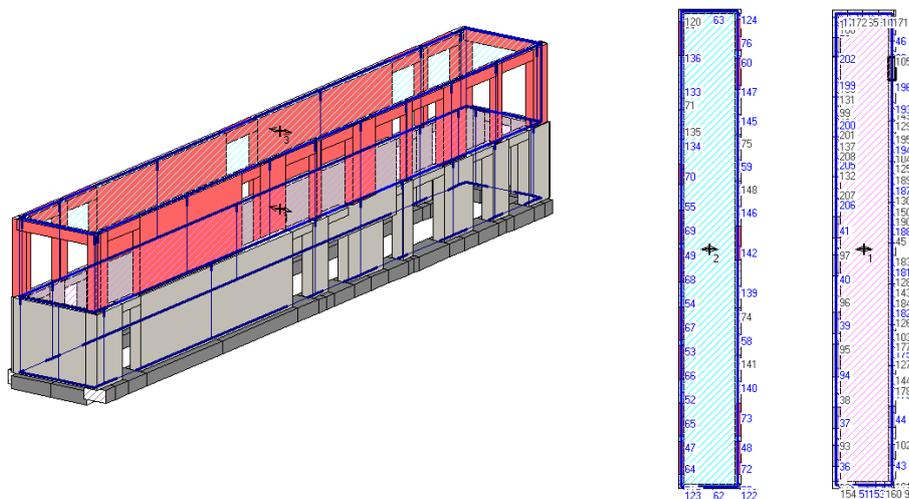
A sinistra: modellazione struttura connettivo. Al centro: Pianta solaio piano terra. A destra: Pianta solaio piano copertura. Ogni pianta presenta i centri di massa. Fonte: Comune di Cesena
